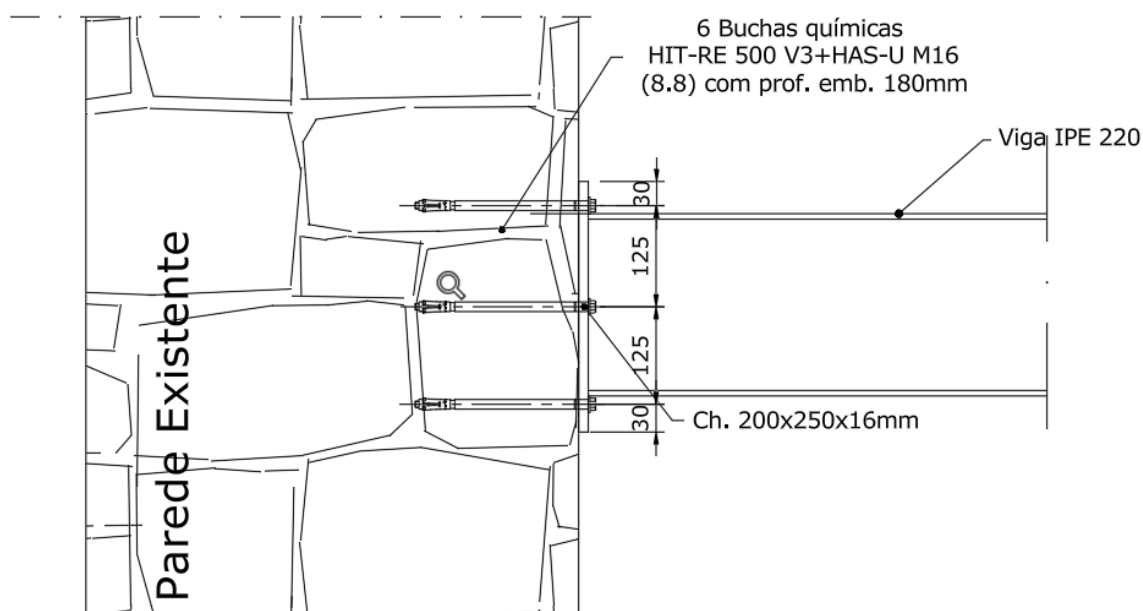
Pormenor construtivo da ligação entre a parede de alvenaria e a viga metálica.
